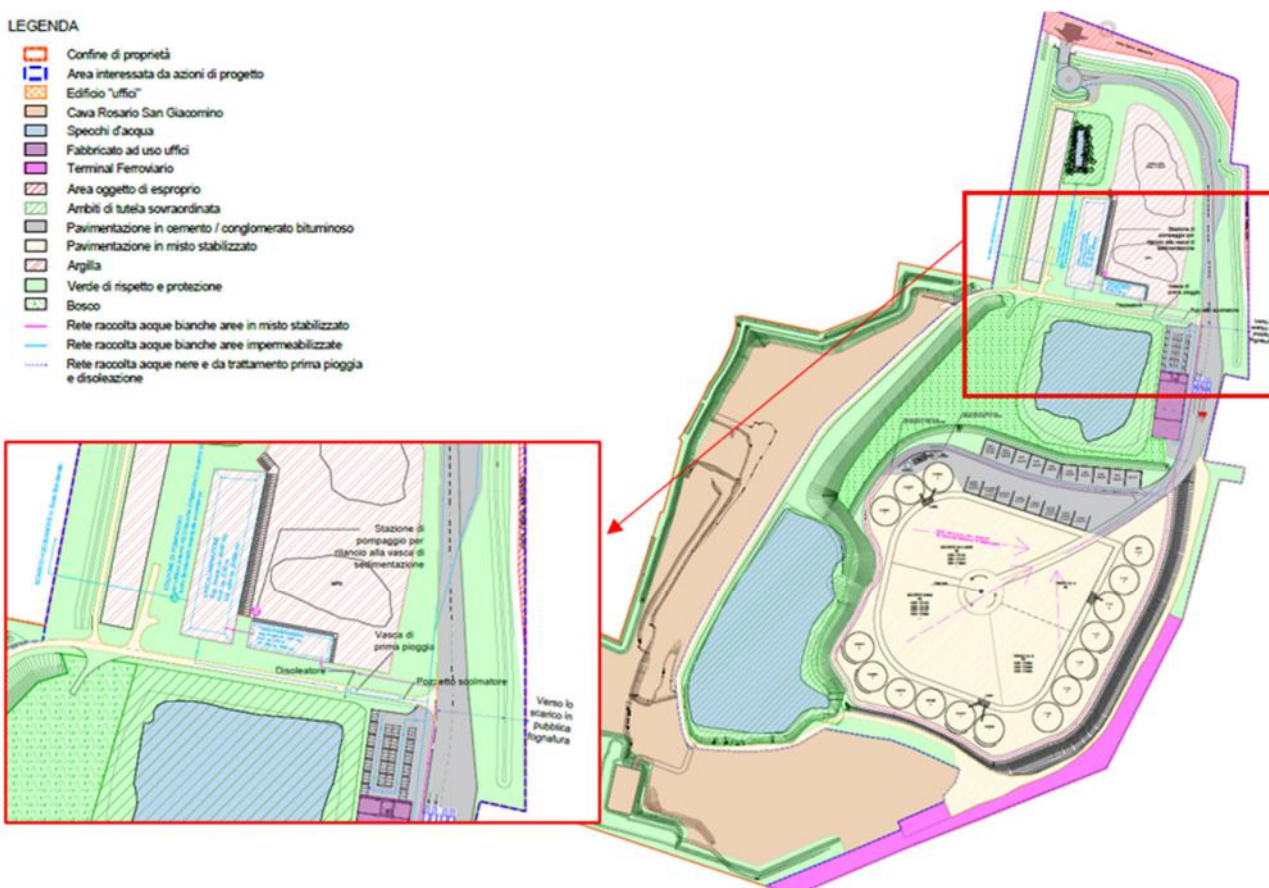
Individuazione vasca di laminazione, sedimentazione e trattamenti (stralcio Tav. PF T10)
